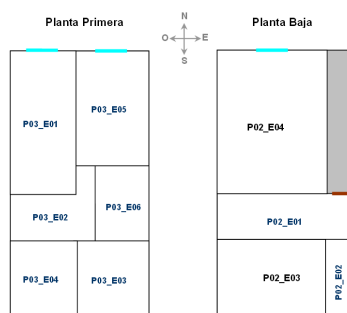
Zonificación de las plantas baja y primera de la vivienda unifamiliar
